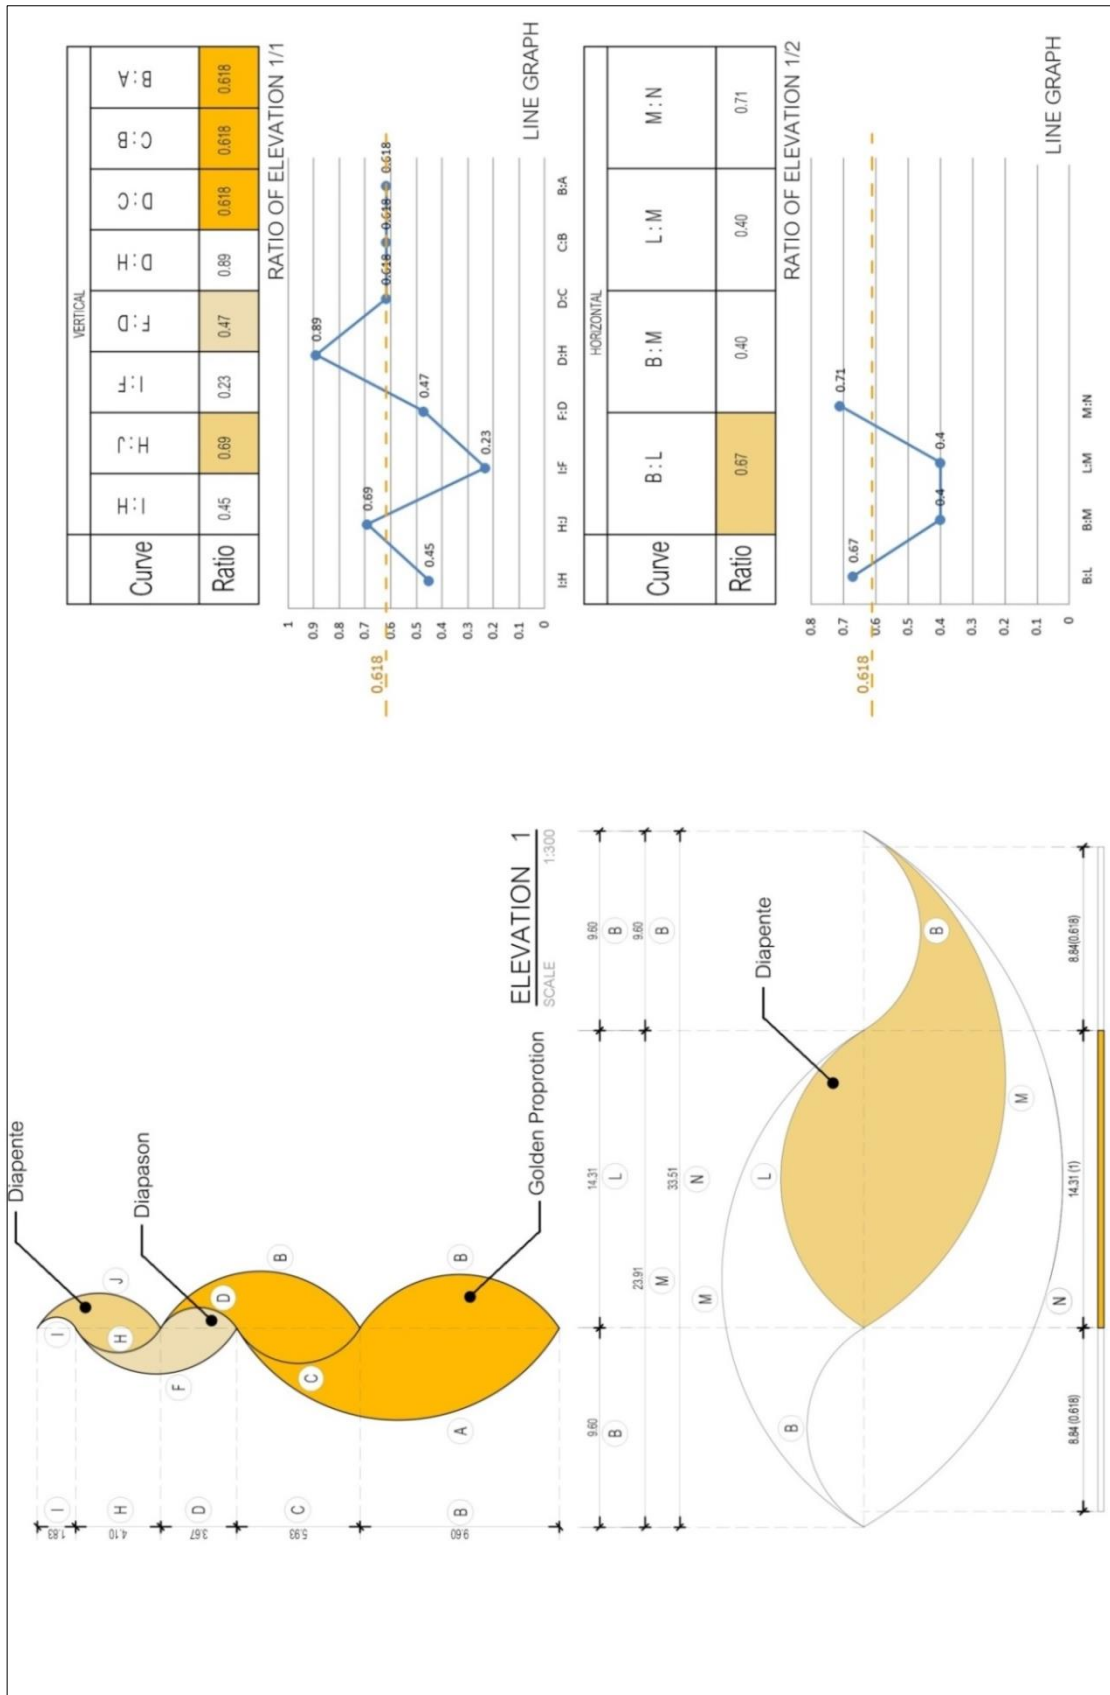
แสดง concept plan บ้านอิน-จัน
